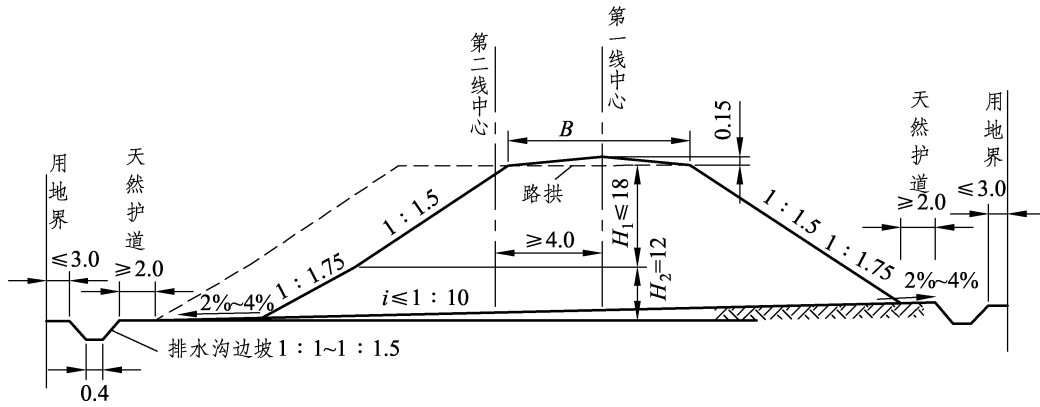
有排水沟路堤典型横断面图 (单位: m)
